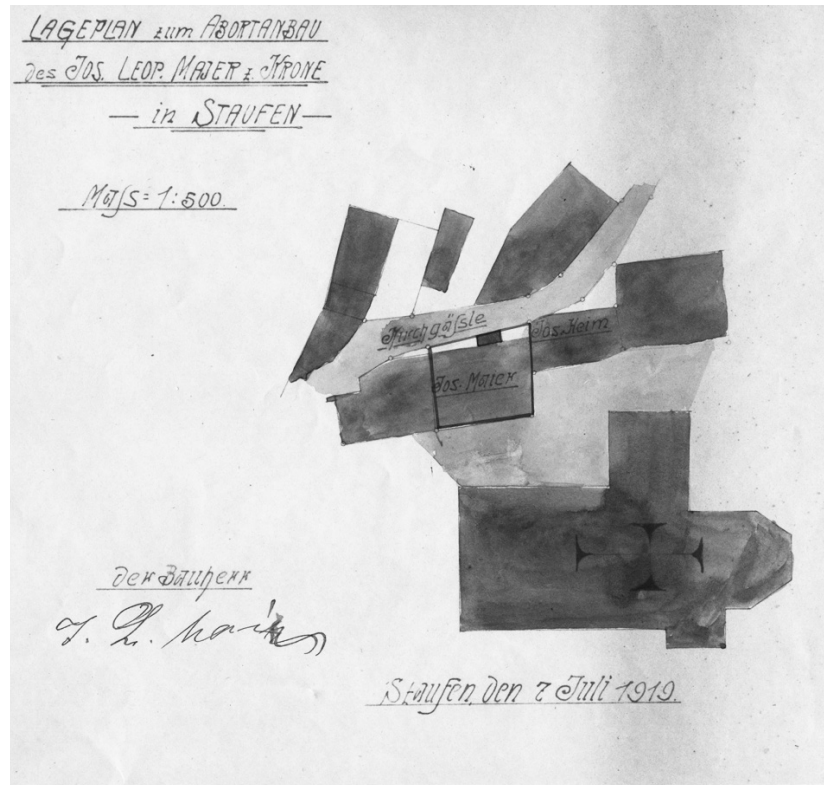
Kirchstraße 11, Lageplan von 1919.
